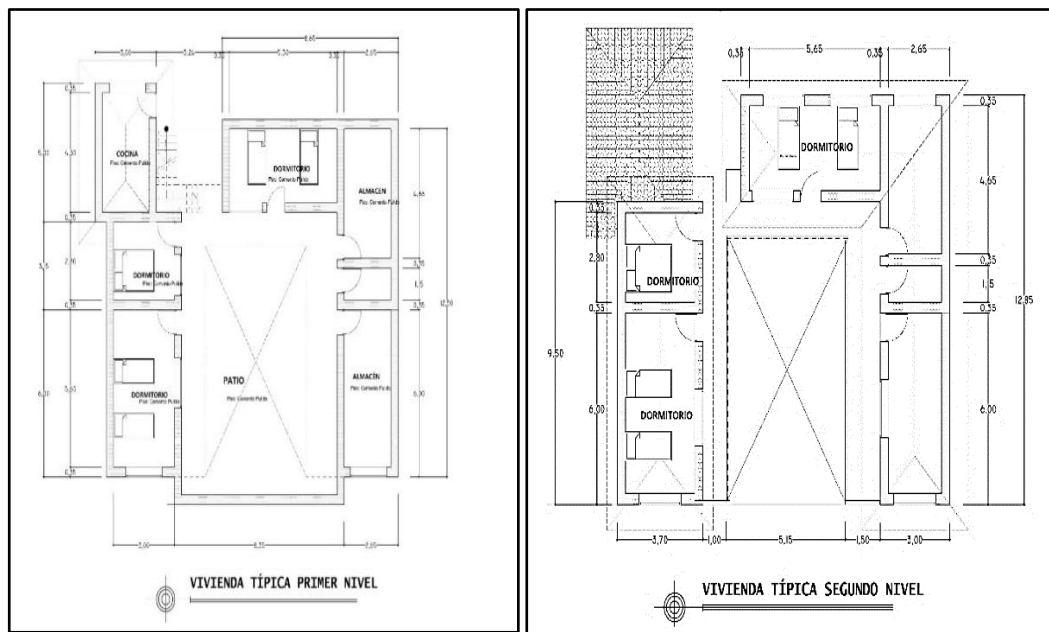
Vista en planta Vivienda típica de dos niveles en la Isla
